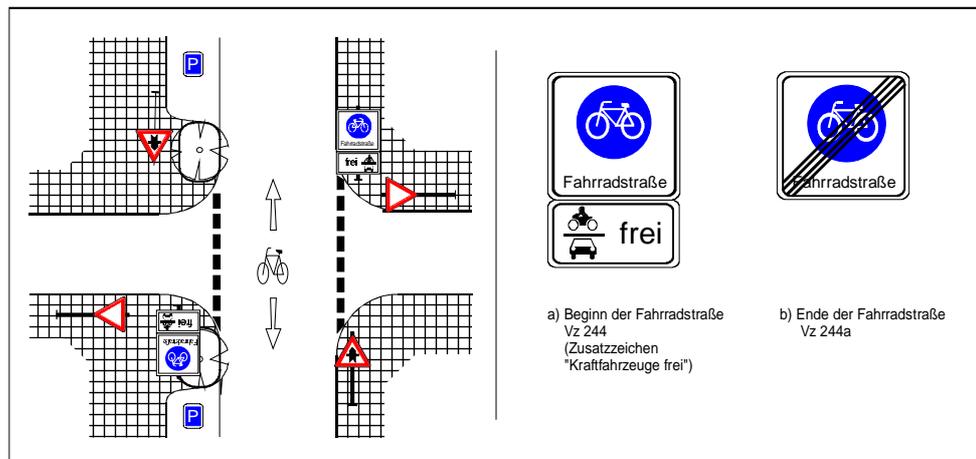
Beschilderung einer Fahrradstraße, hier mit Vorrang der Nebenstraße
